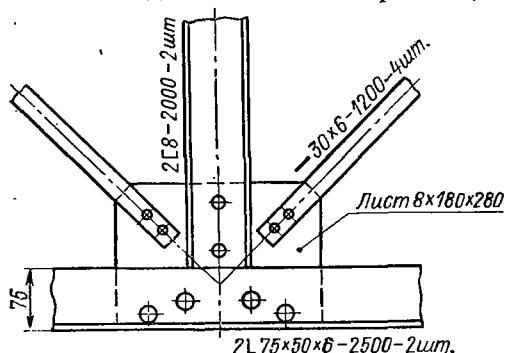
Нанесение размеров на чертежах металлических конструкций
